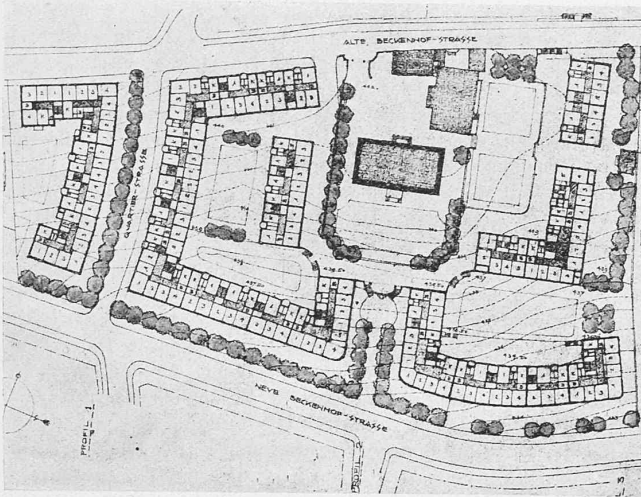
und 13. Lagepläne mit und ohne altem „Beckenhof“ (1:2000). — Entwurf Nr. 1, Arch. Gebr. Bräm, Zürich.
